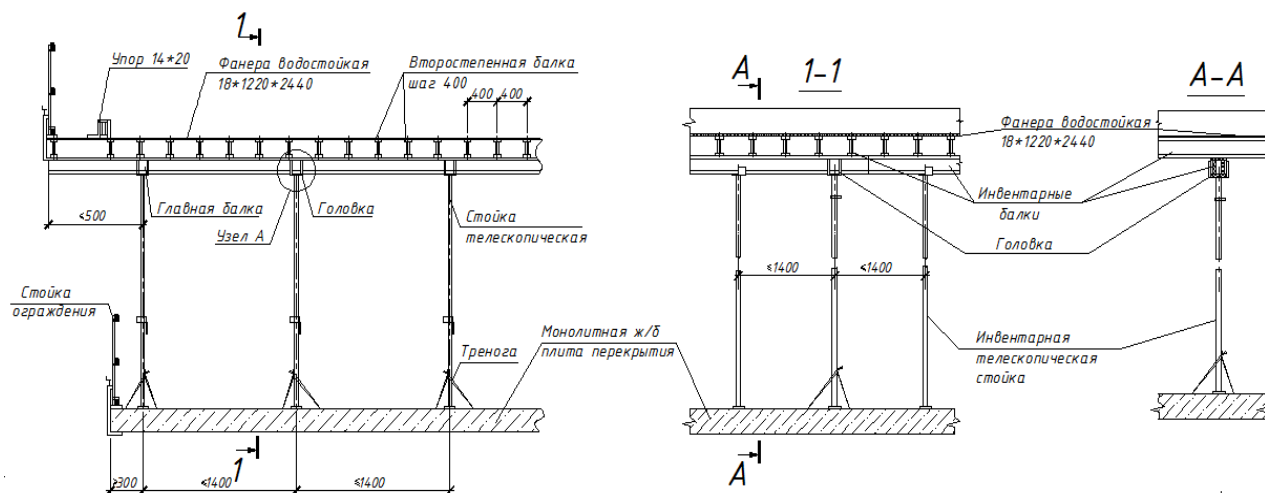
Принципиальная схема монтажа опалубок перекрытия
